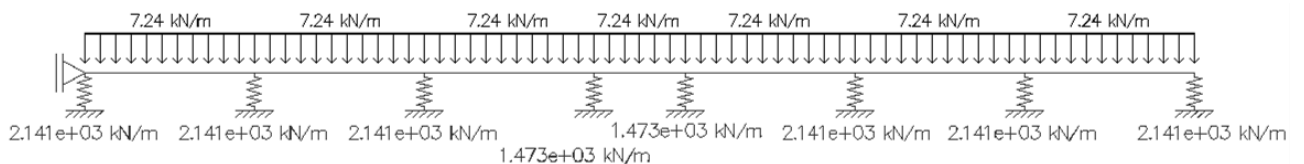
25 – Esquema estrutural do pavimento para determinação dos esforços em seu plano.
